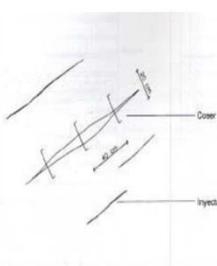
Una pared de mampostería en un caso de grietas cosido con grapas. Este método puede emplearse en los casos de fisuras.
